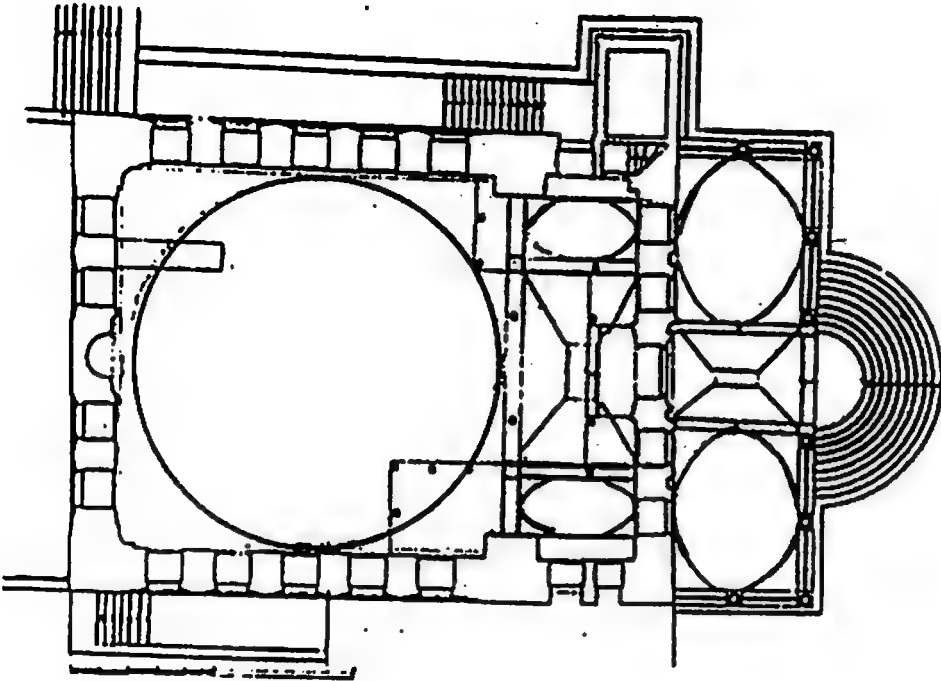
للمسقط الأقي لجامع يلدريم بايزيد في بورصة.
